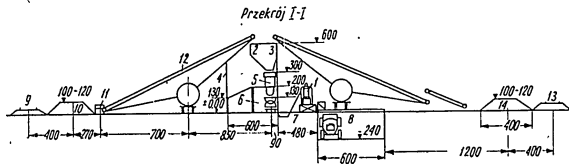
Ruchoma wytwórnica betonu o 1 betoniarkę 375—500 litr. 1 — betoniarka, 2 — pryzmy kruszywa, 3 — ruchomy przenośnik, 4 — przenośnik zasila- jące, 5 — część wytwórnicy zawierająca zasobniki i dozatory, 6 — magazyn cementu
